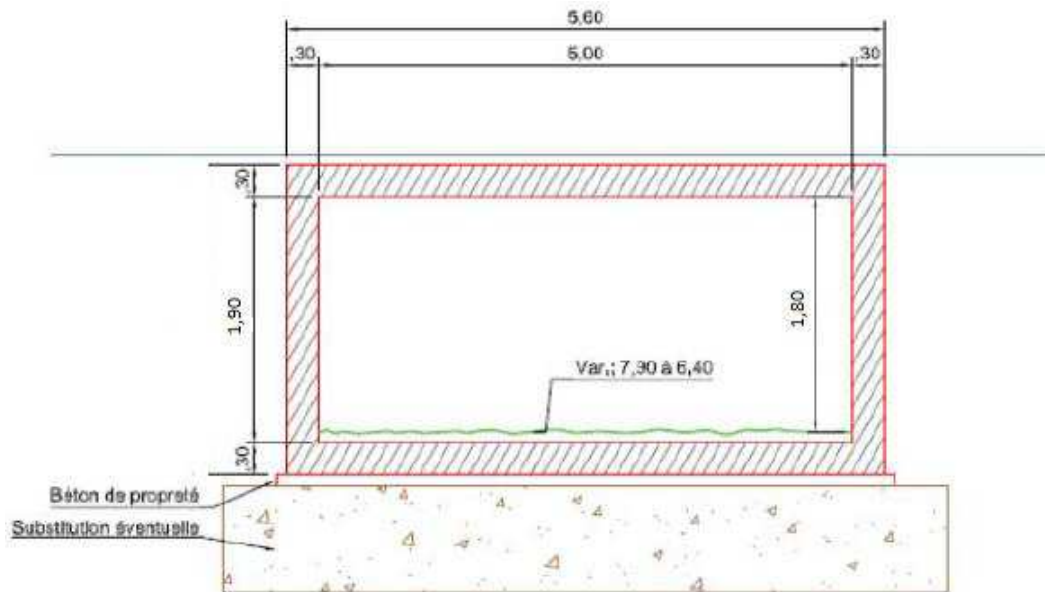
Schéma de l'ouvrage hydraulique sur la ravine Deschenez (Source : Egis)
